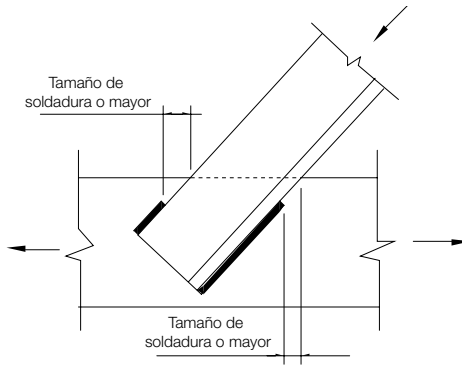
Soldaduras de filete cerca de bordes en tracción.
